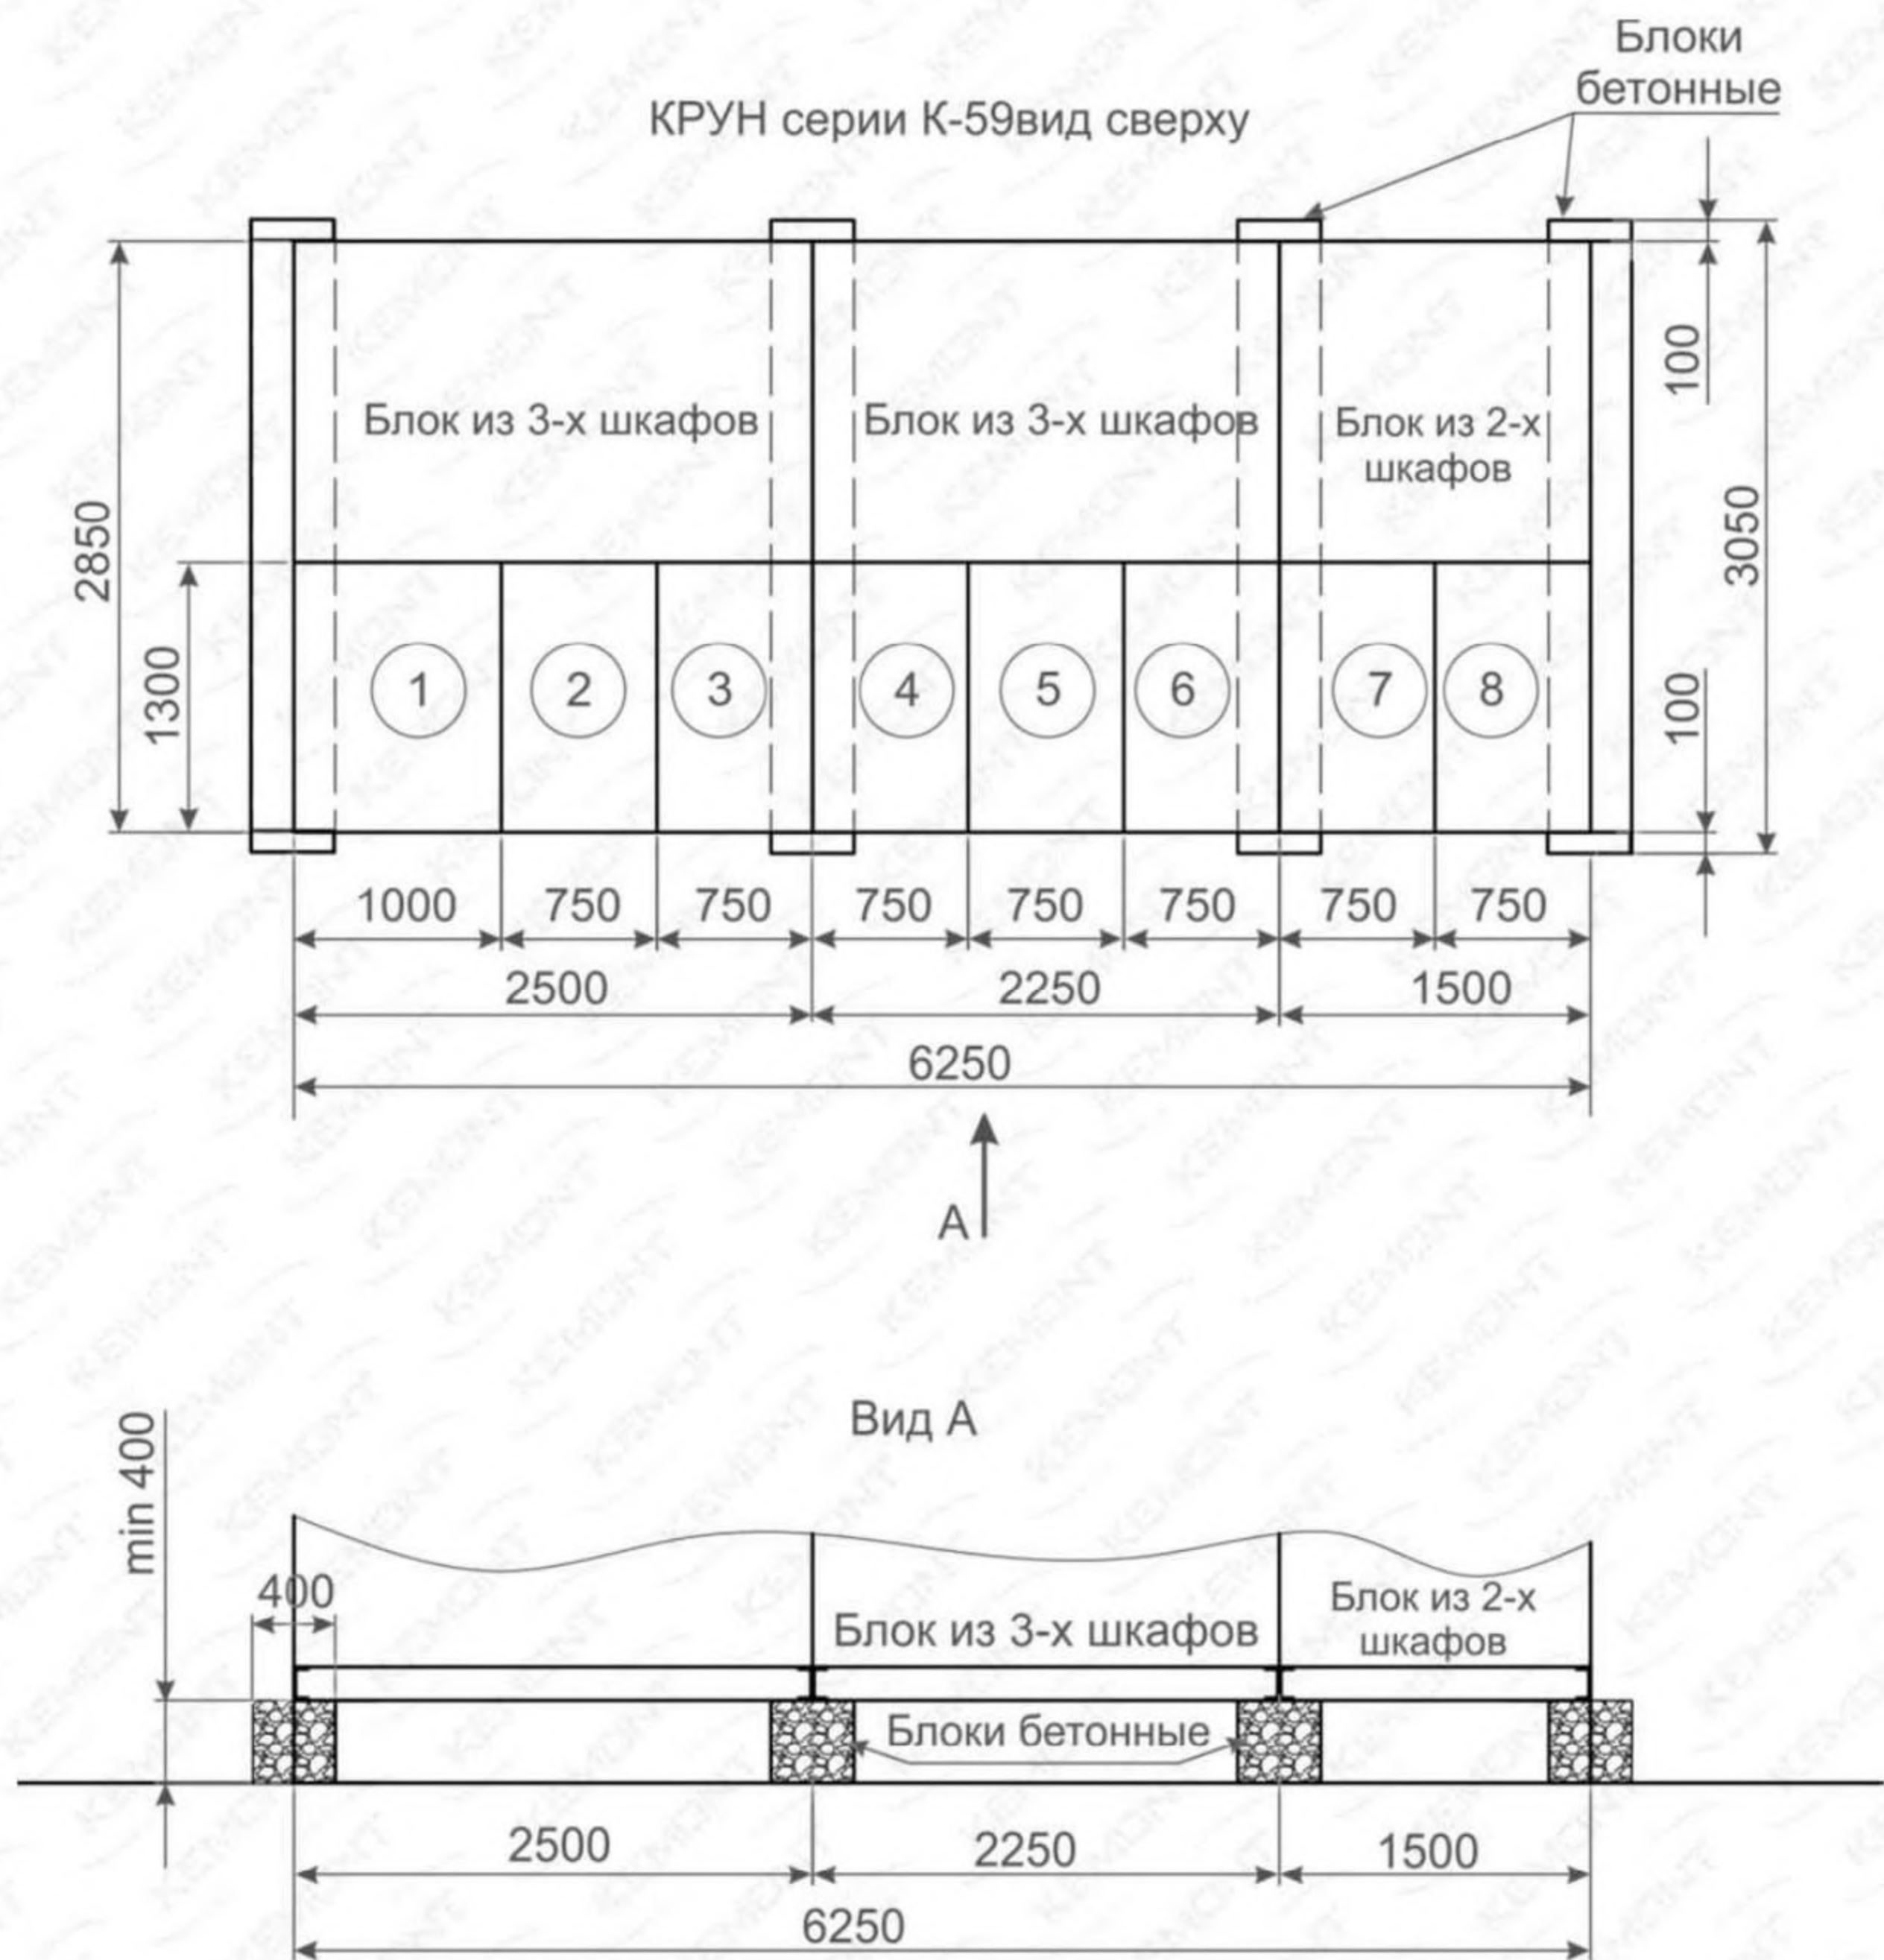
План фундаментов для различных размеров блоков КРУН К-59
